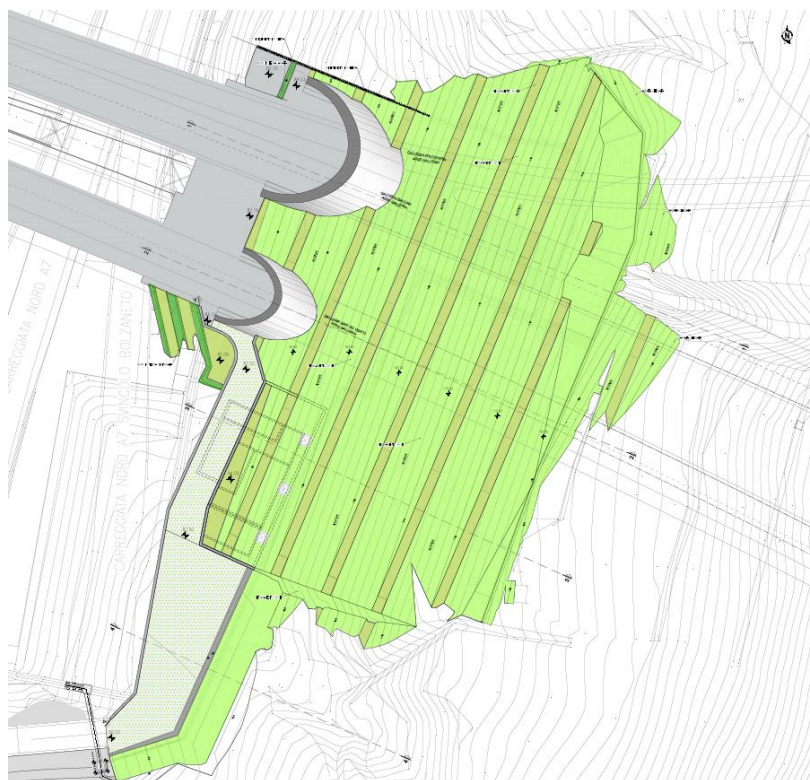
Planimetria delle sistemazioni finali dell'imbocco Polcevera/Bric du Vento/Baccan
